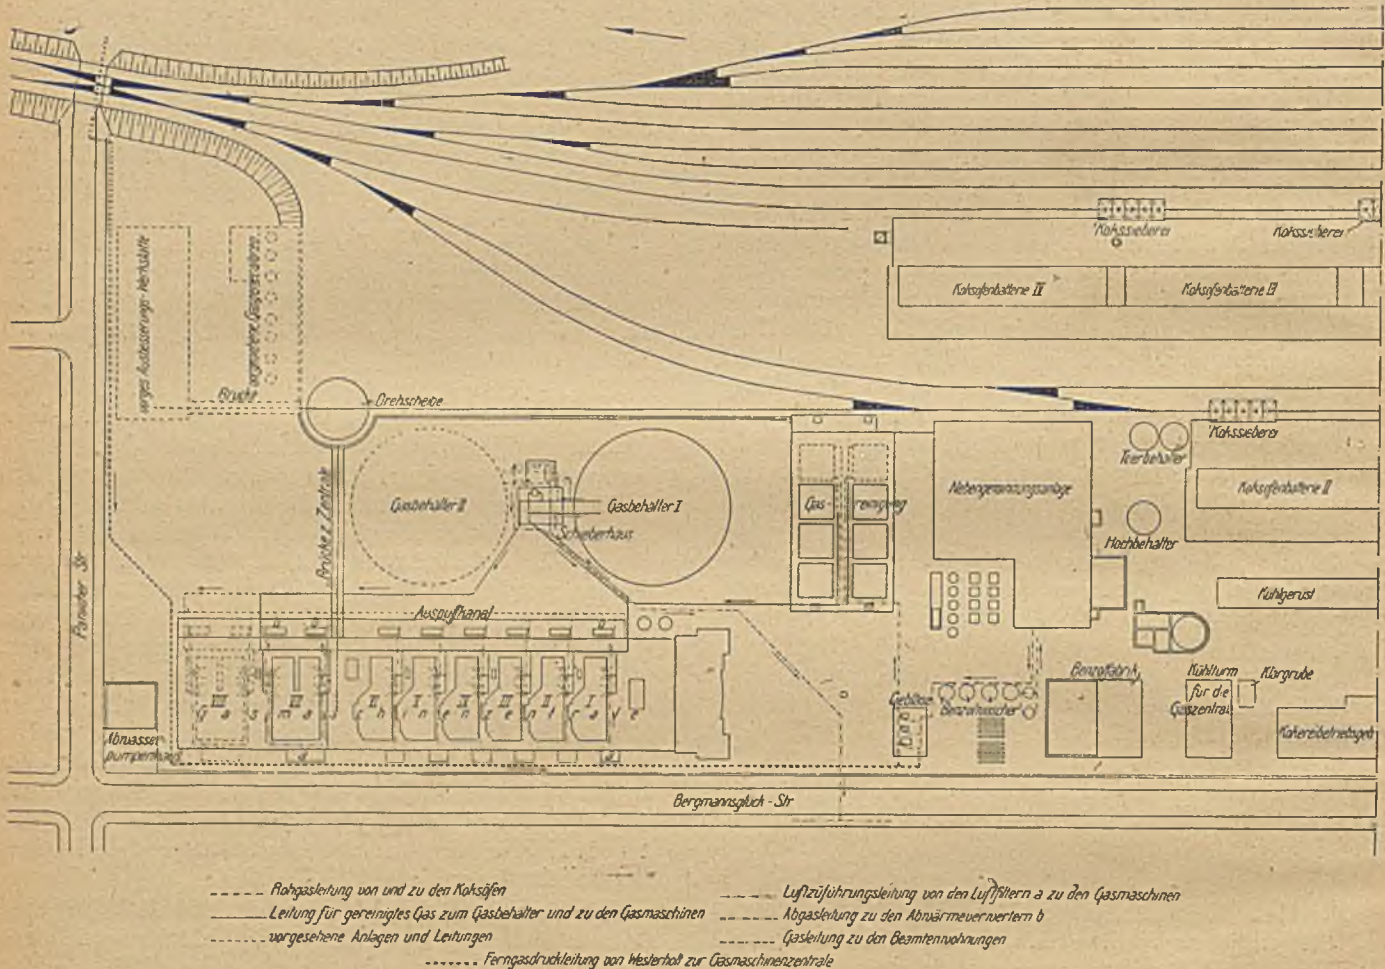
Lageplan des Gaskraftwerkes mit Hilfsanlagen.
